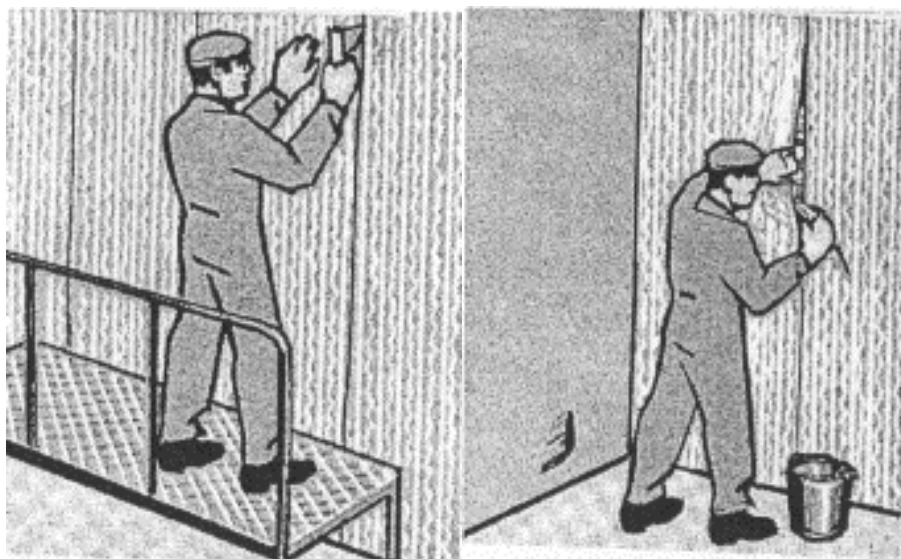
Обработка стыков и очистка виниловых обоев
